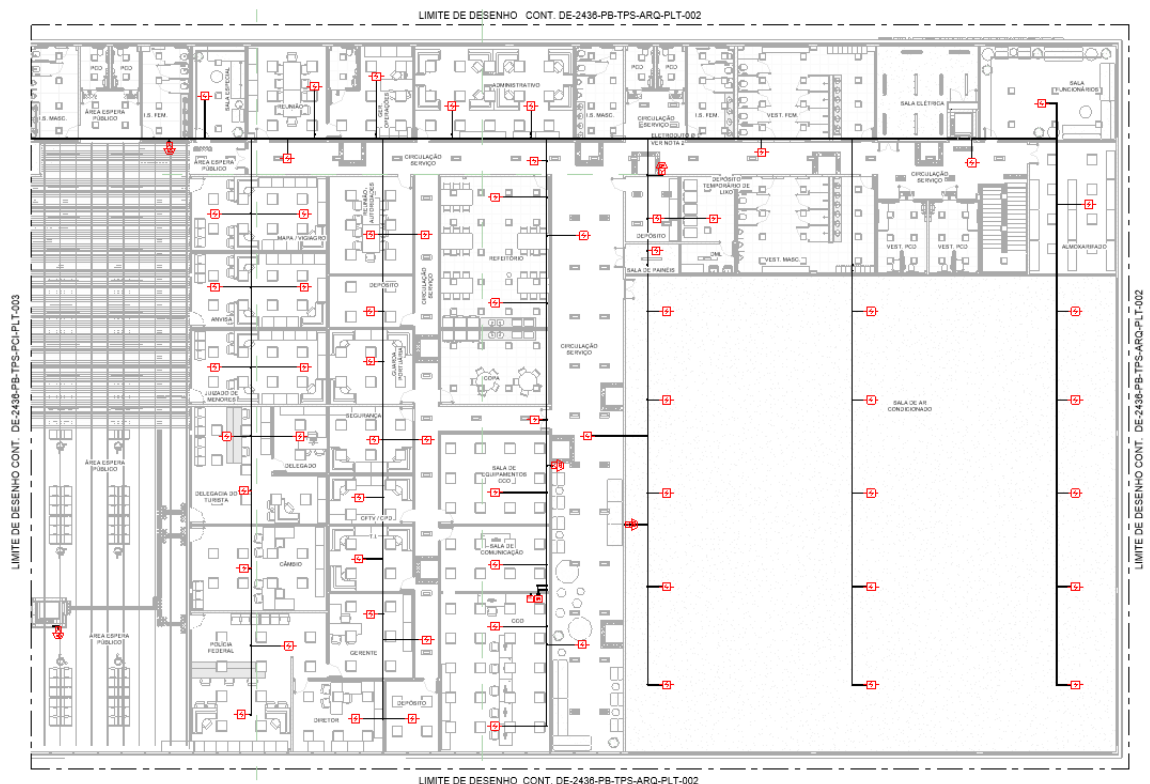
Arranjo dos detectores no primeiro pavimento lado leste.
